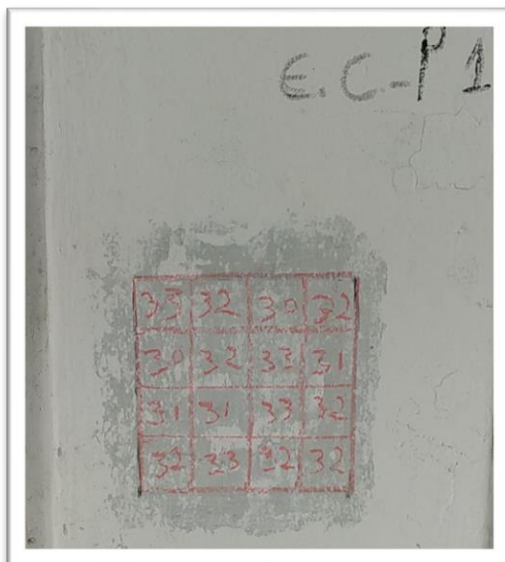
Lectura de disparos en la columna “P-1” del pabellón 11 – bloque A.
